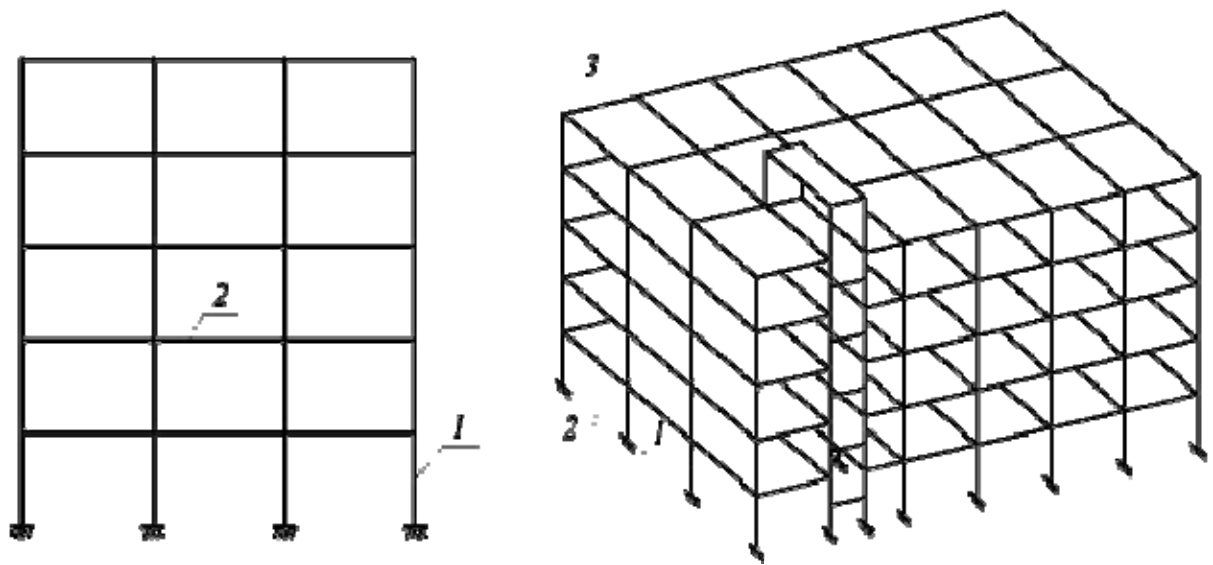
Принципиальная компоновка рамной конструктивной схемы здания: 1- колонны, 2- ригели, 3- перекрытия
